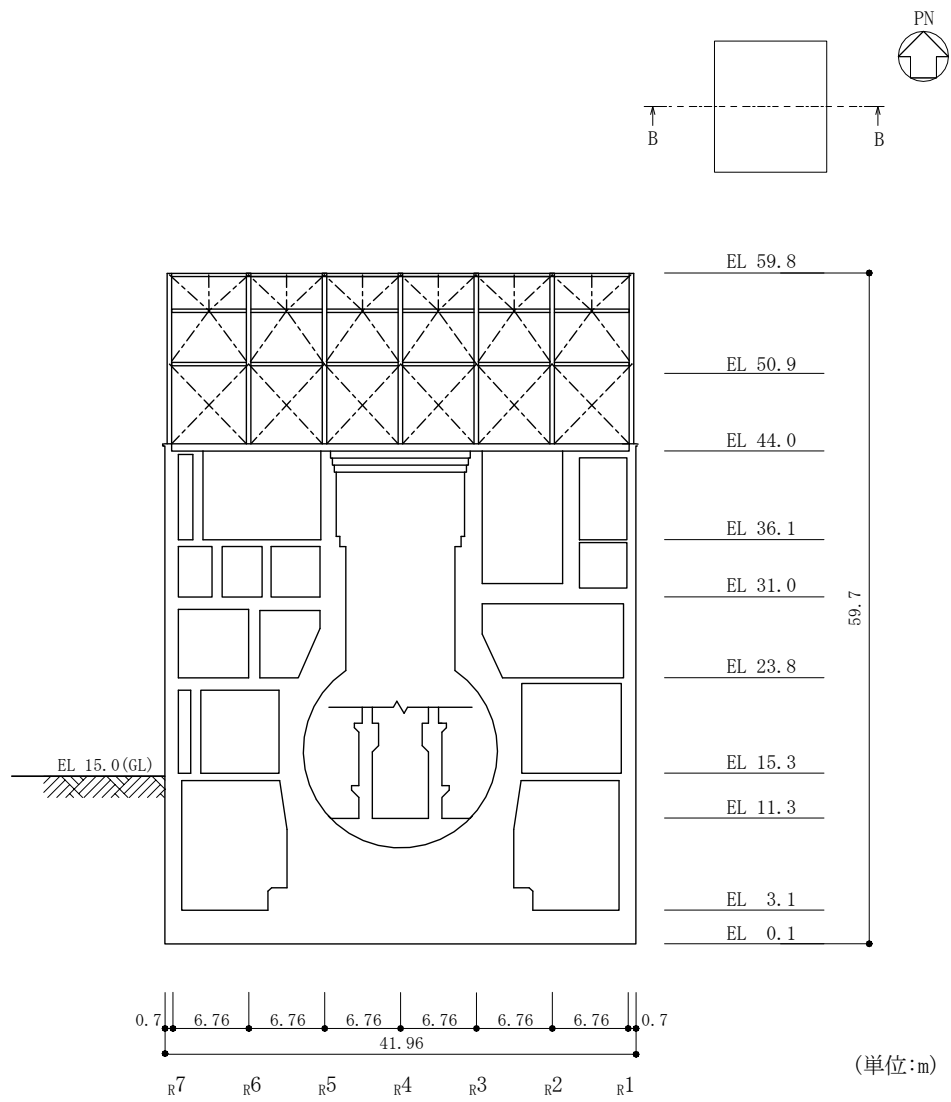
(2) 1号機原子炉建物の概略断面図 (B-B断面, EW方向)
